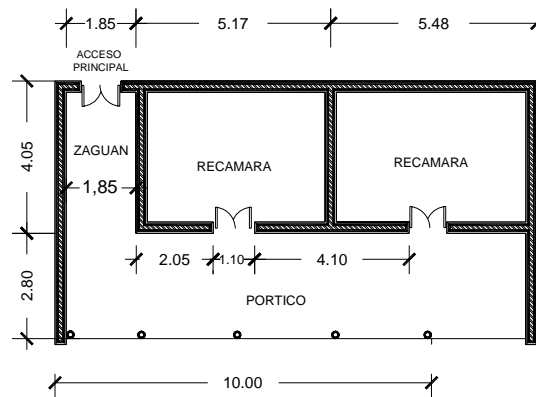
Planta tipo del esquema arquitectónico del área habitacional
